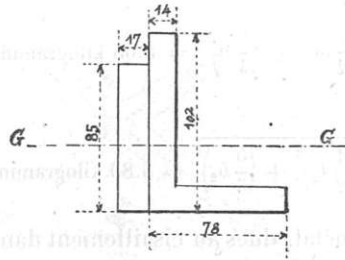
Section transversale de la ventrière au niveau du plancher.
